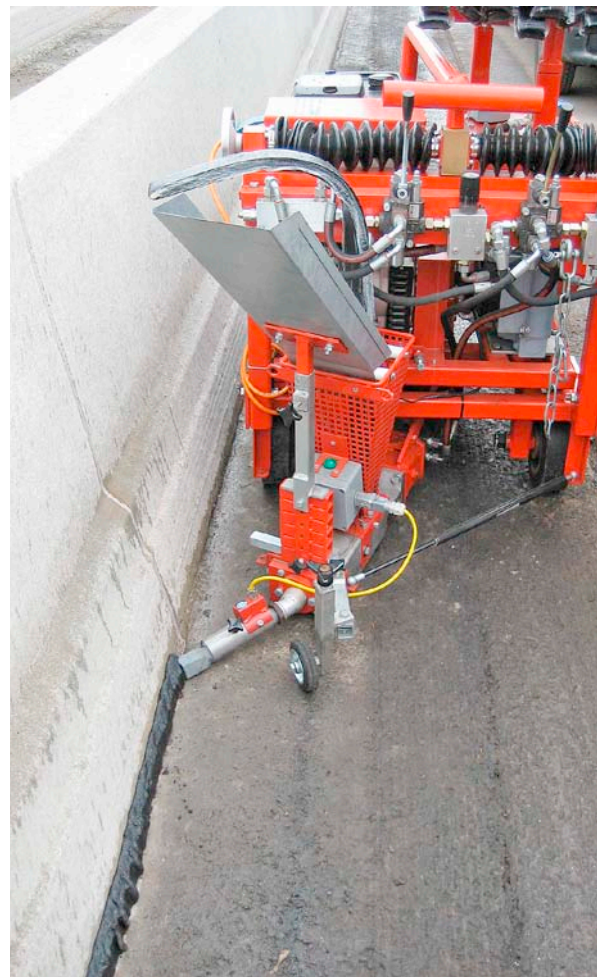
Einbau des Bitumenfugenbandes an einer Betongleitwand mit dem Tokomat
